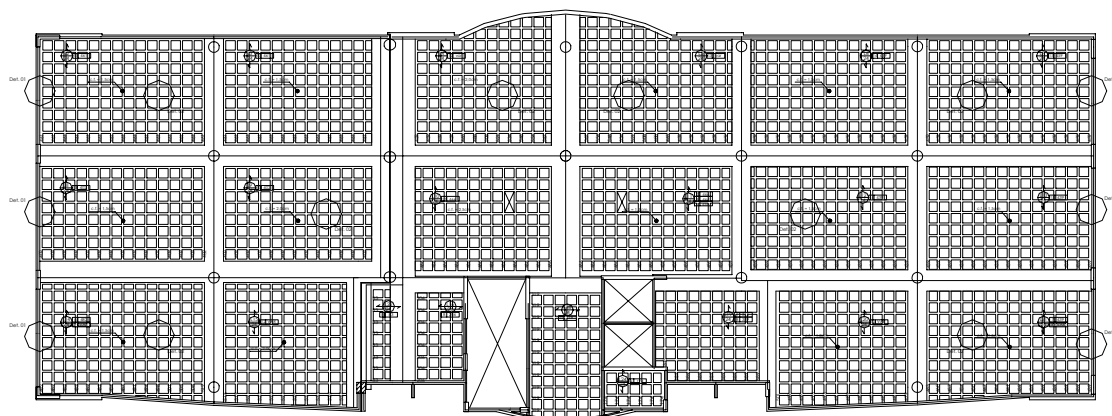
Laje plana com vigas “chatas” (Projeto: Eng. Jano D’Araújo Coelho, Msc.).
